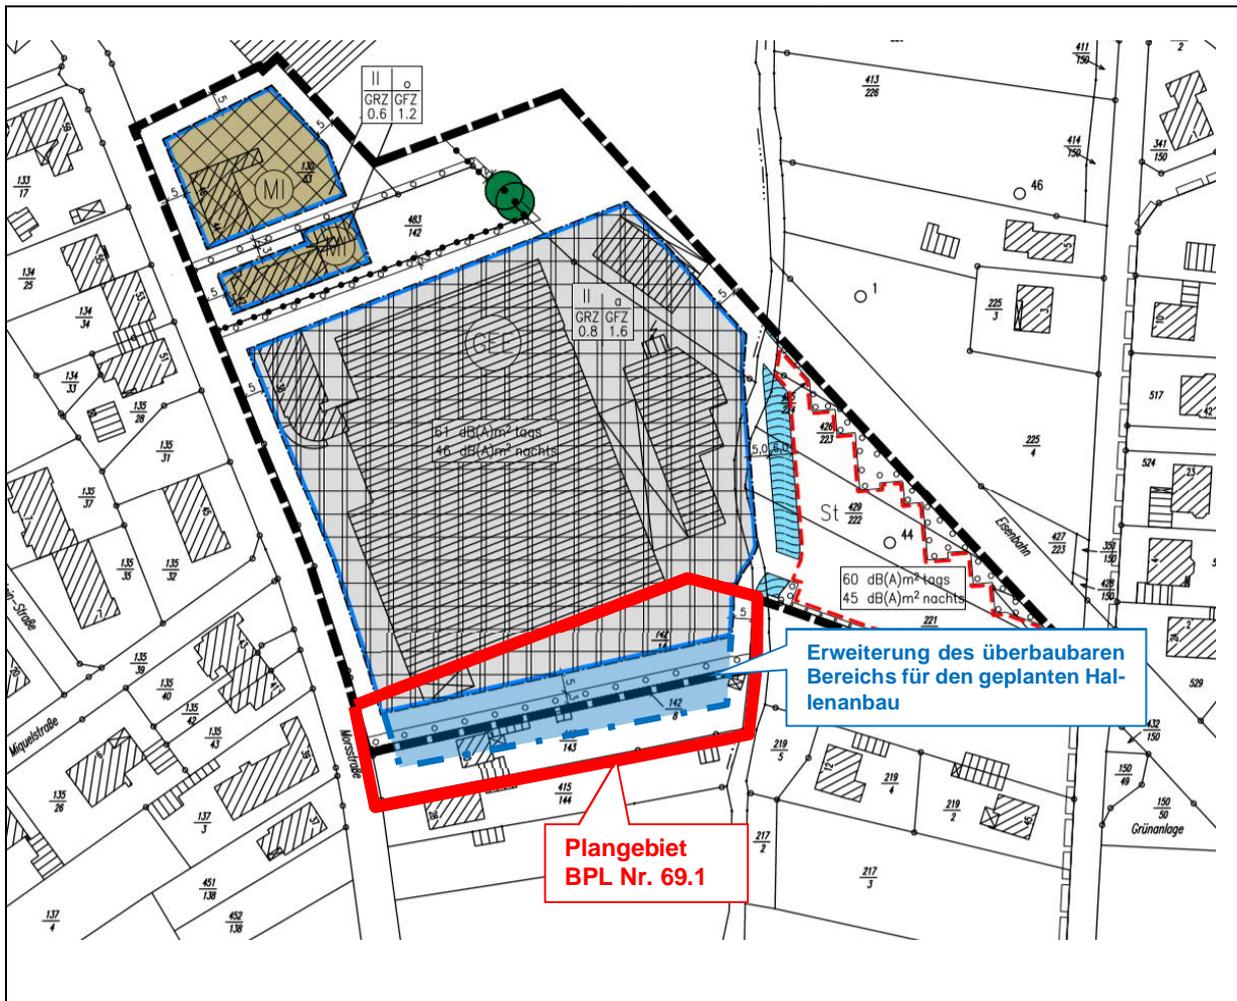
Bebauungsplan Nr. 69 (Ausschnitt ohne Maßstab)
